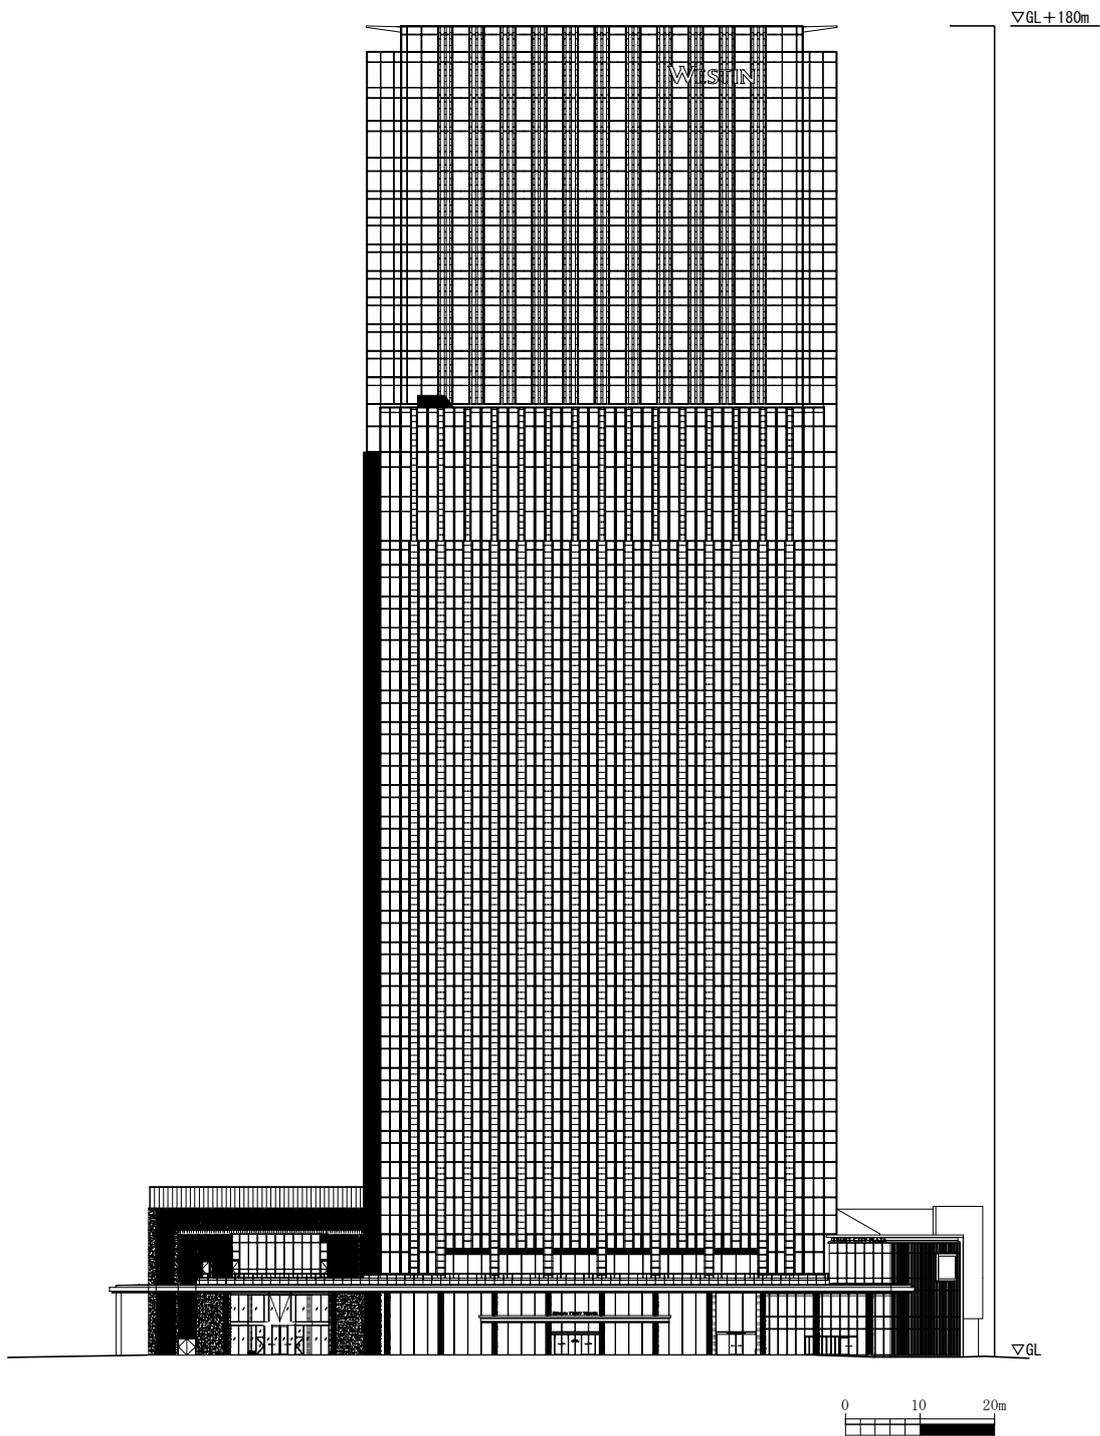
(1) 計画建築物立面图 (東側) (完成(竣工))
